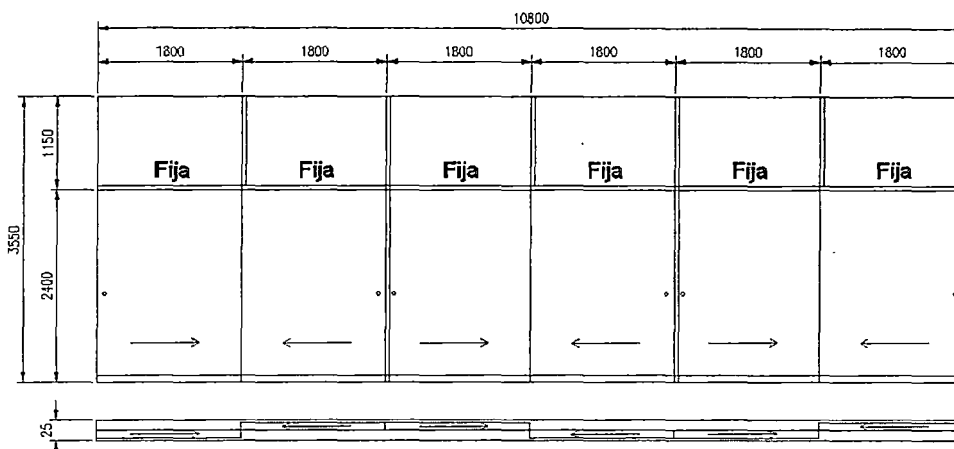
Vista de fachada frente a Av. Diez Canseco. Proyecto NEO 10
